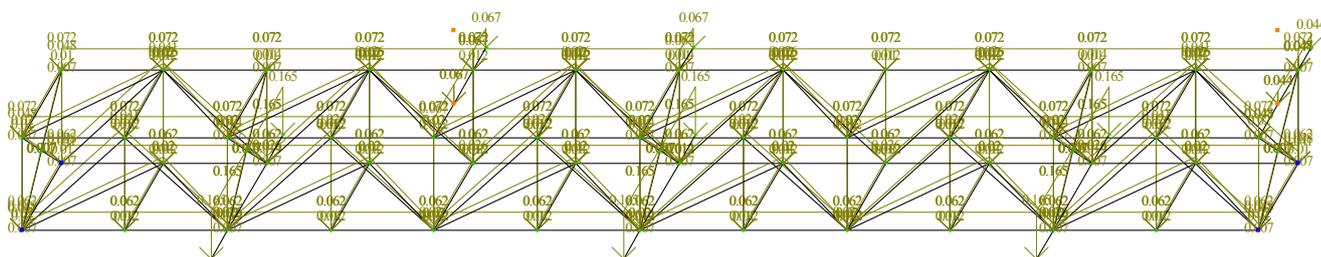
Вертикальные нагрузки от собственного веса конструкций ферм
